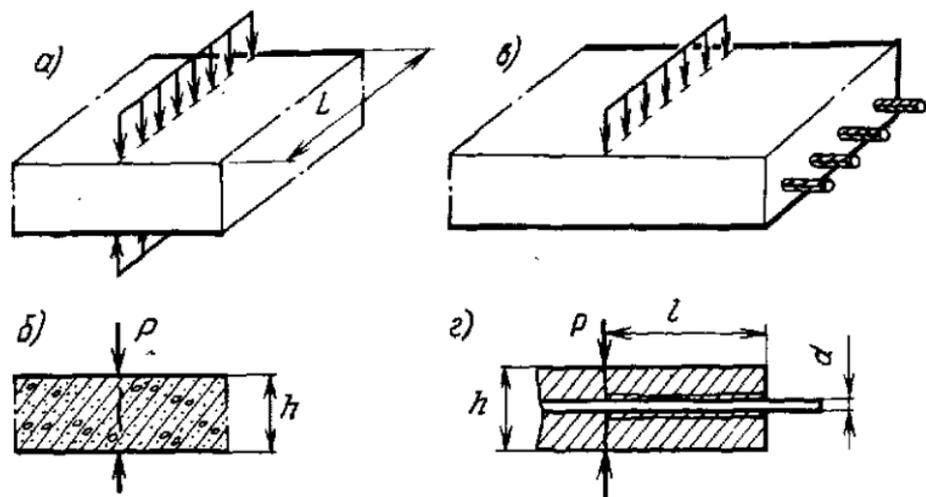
Схемы загрузки бетонных и железобетонных изделий при разрушении
